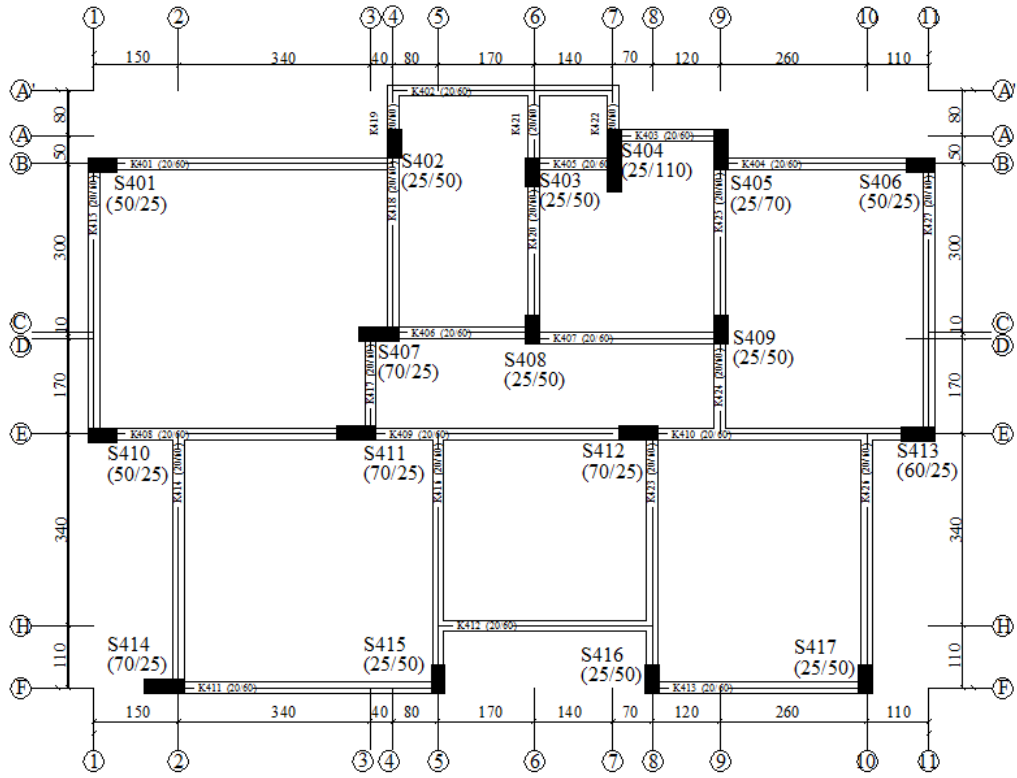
4K-B8 nolu binanın kalıp planı
